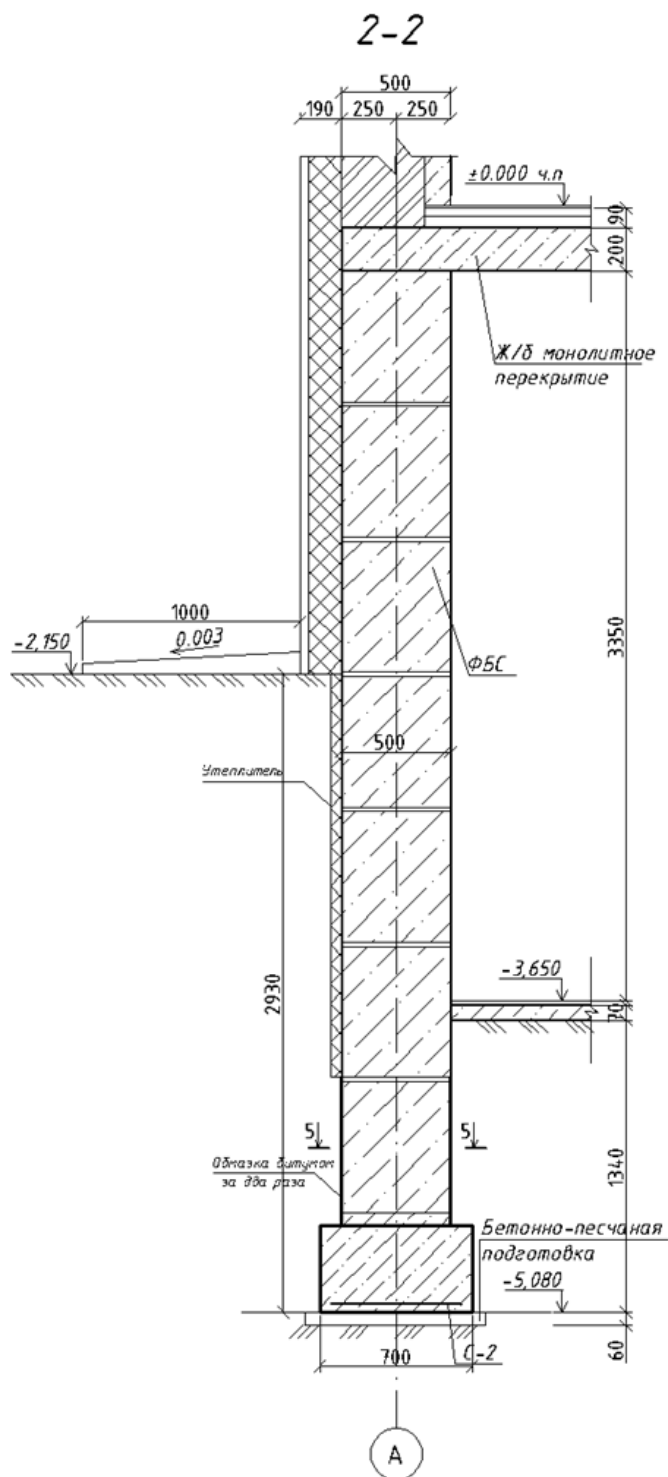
Конструктивная схема ленточного монолитного фундамента в сечении 2-2
